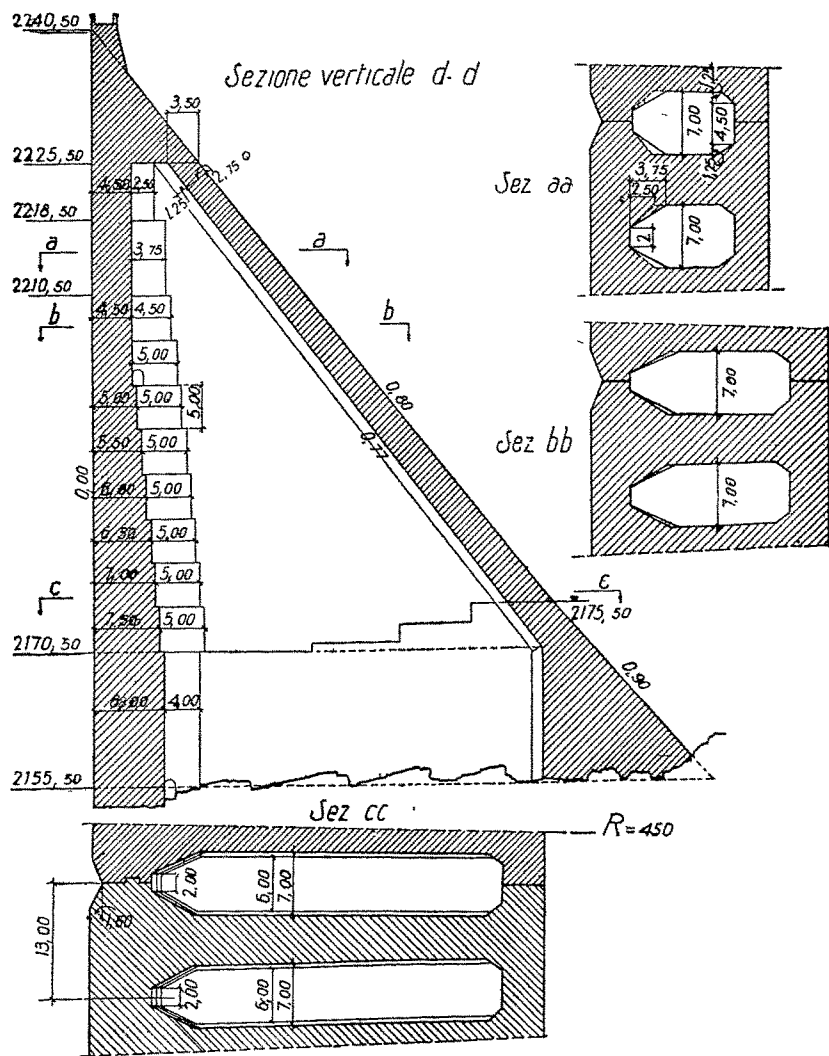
Barrage sur la Dixence (projet), coupe verticale
